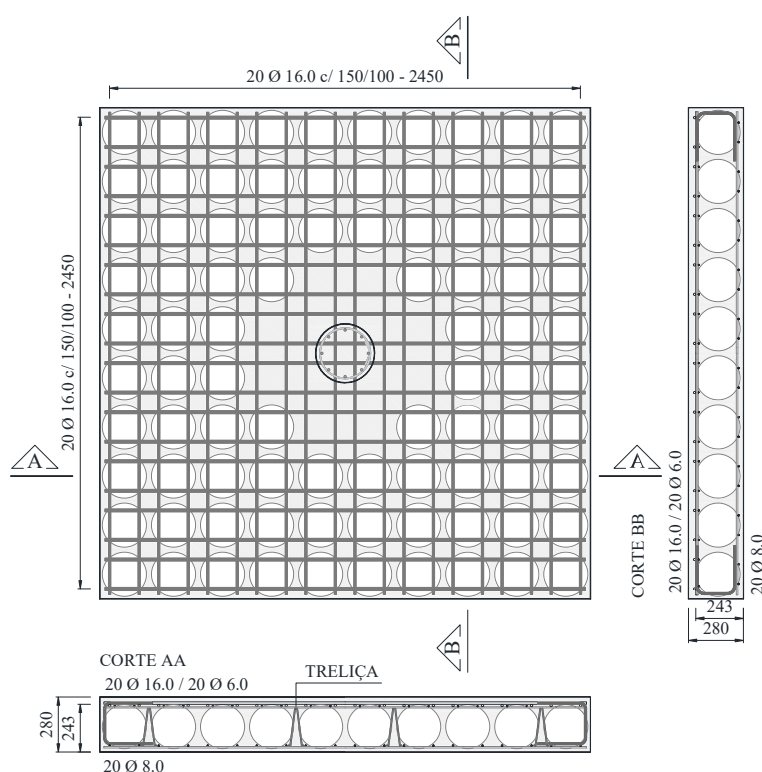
Armadura das lajes, CEBALLOS (2017)
